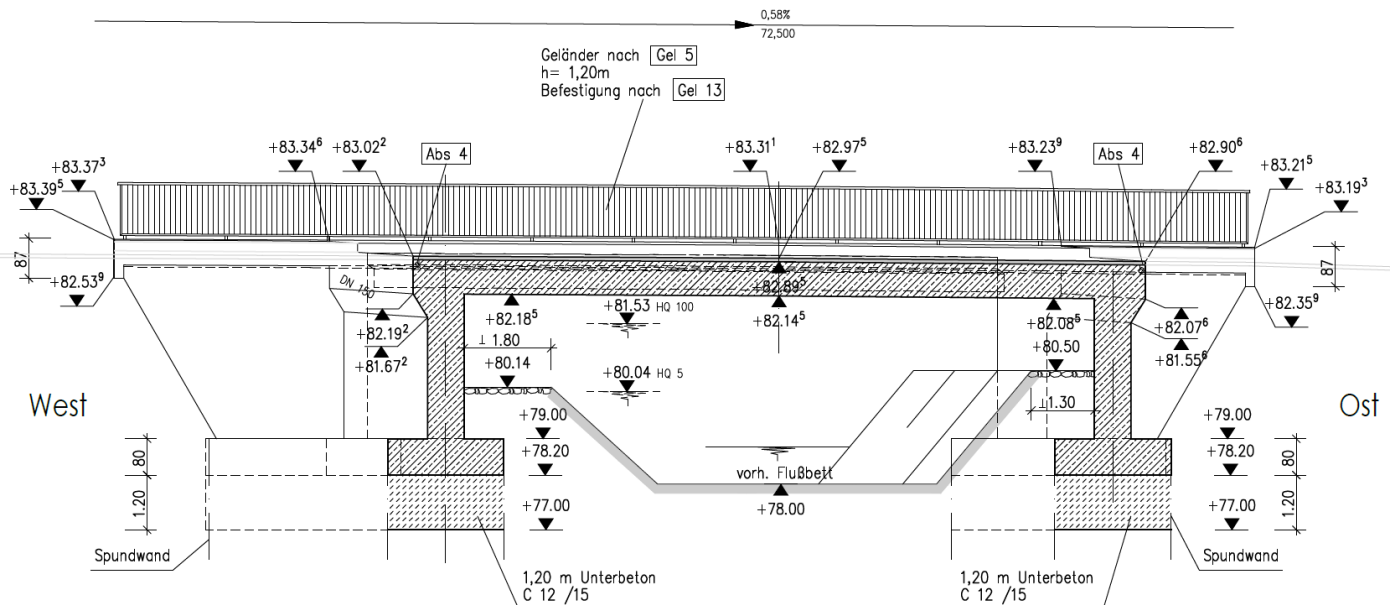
Entwurfsplanung zum Brückenbauwerk (Längsschnitt) (ICL 05/2020)
